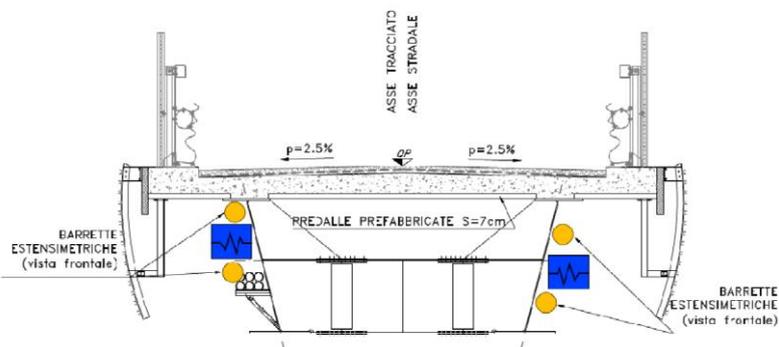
Sezioni tipo impalcato posizionamento strumentazioni cavalcavia
